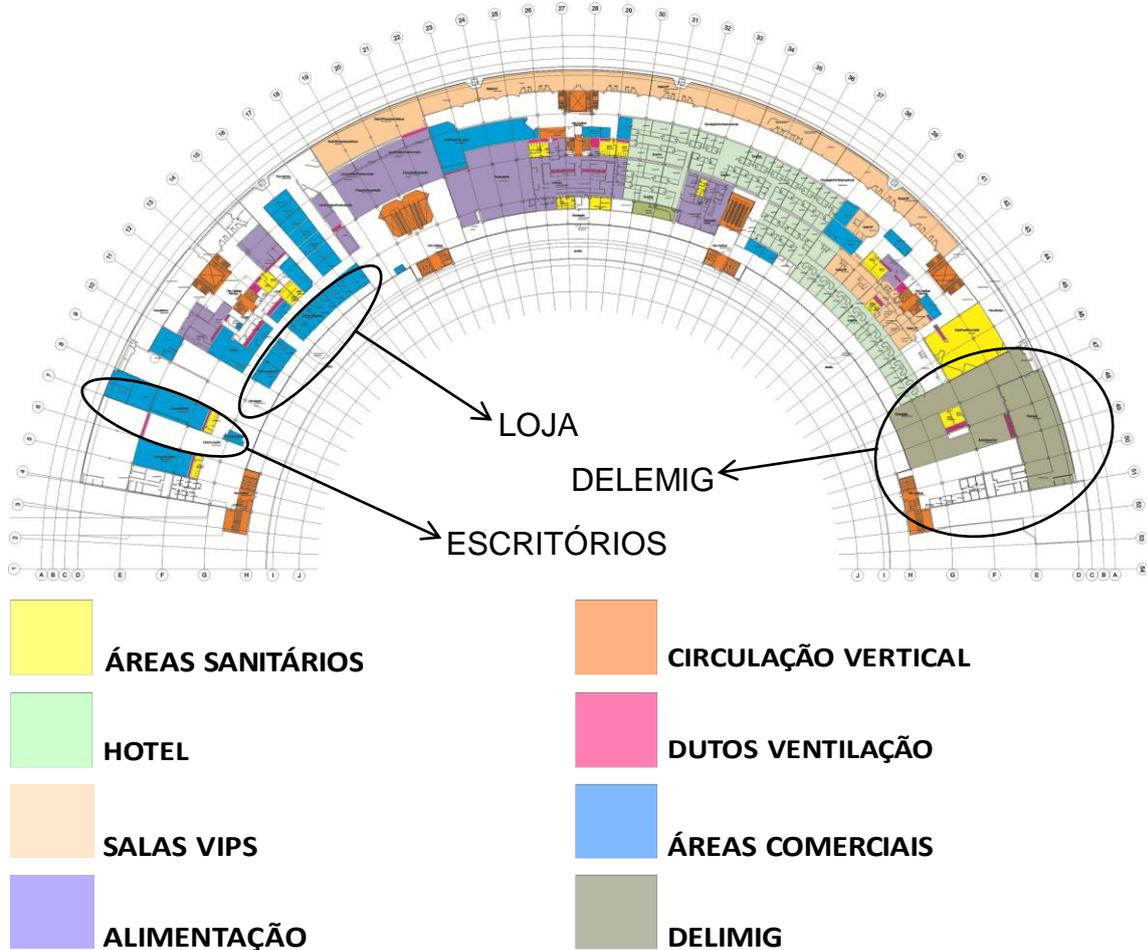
Planta do pavimento comercial, salas VIPs e terraço panorâmico
